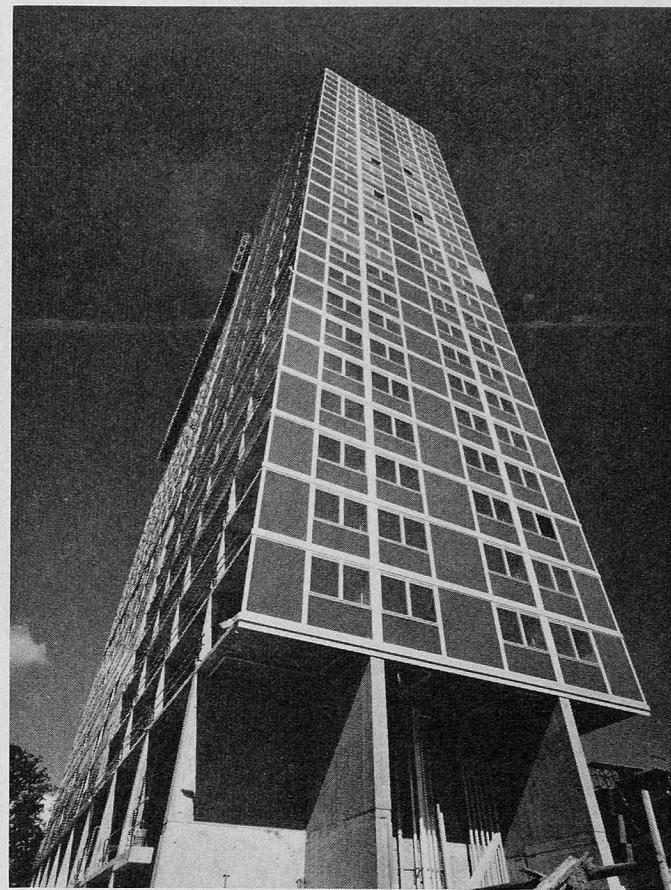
Hochhaus mit 26 Etagen, Schmalseite, Fassade in Verbundkonstruktion (Aluminium, Holz, Glas)
